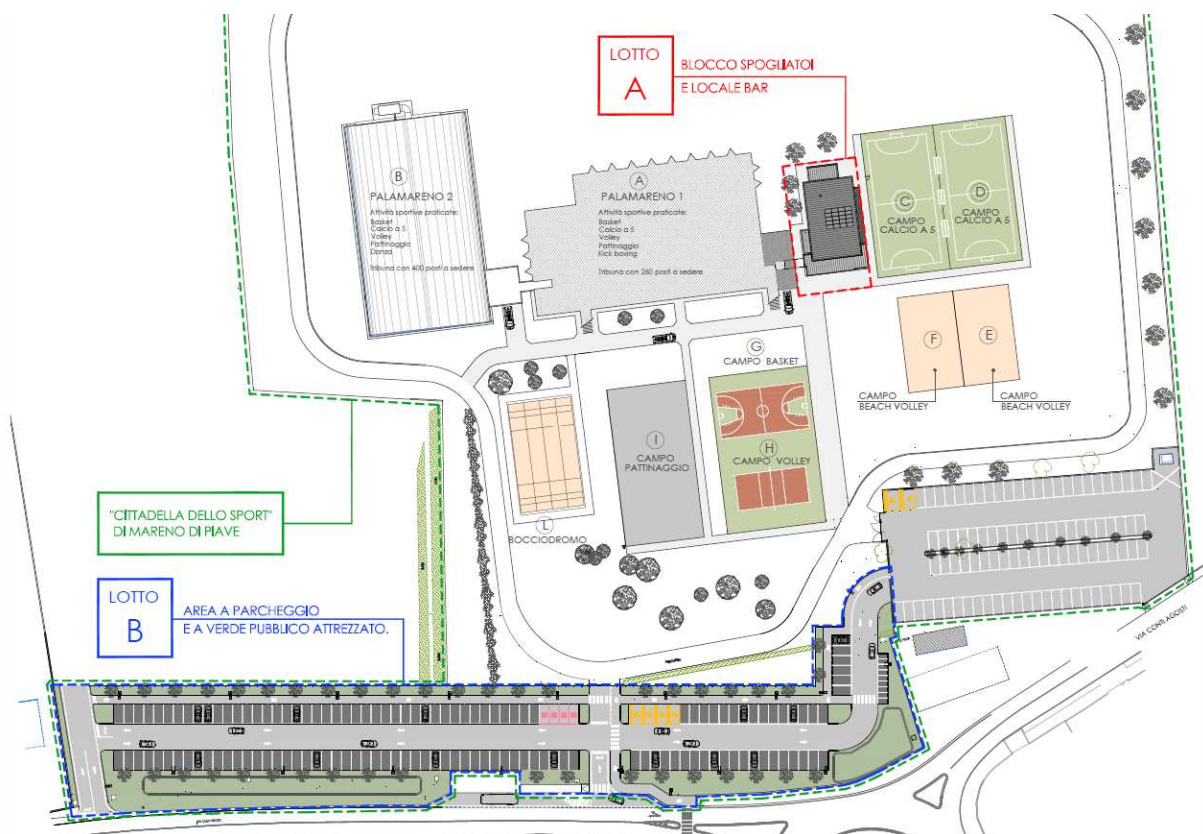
INDIVIDUAZIONE DEI LOTTI DI PROGETTO
